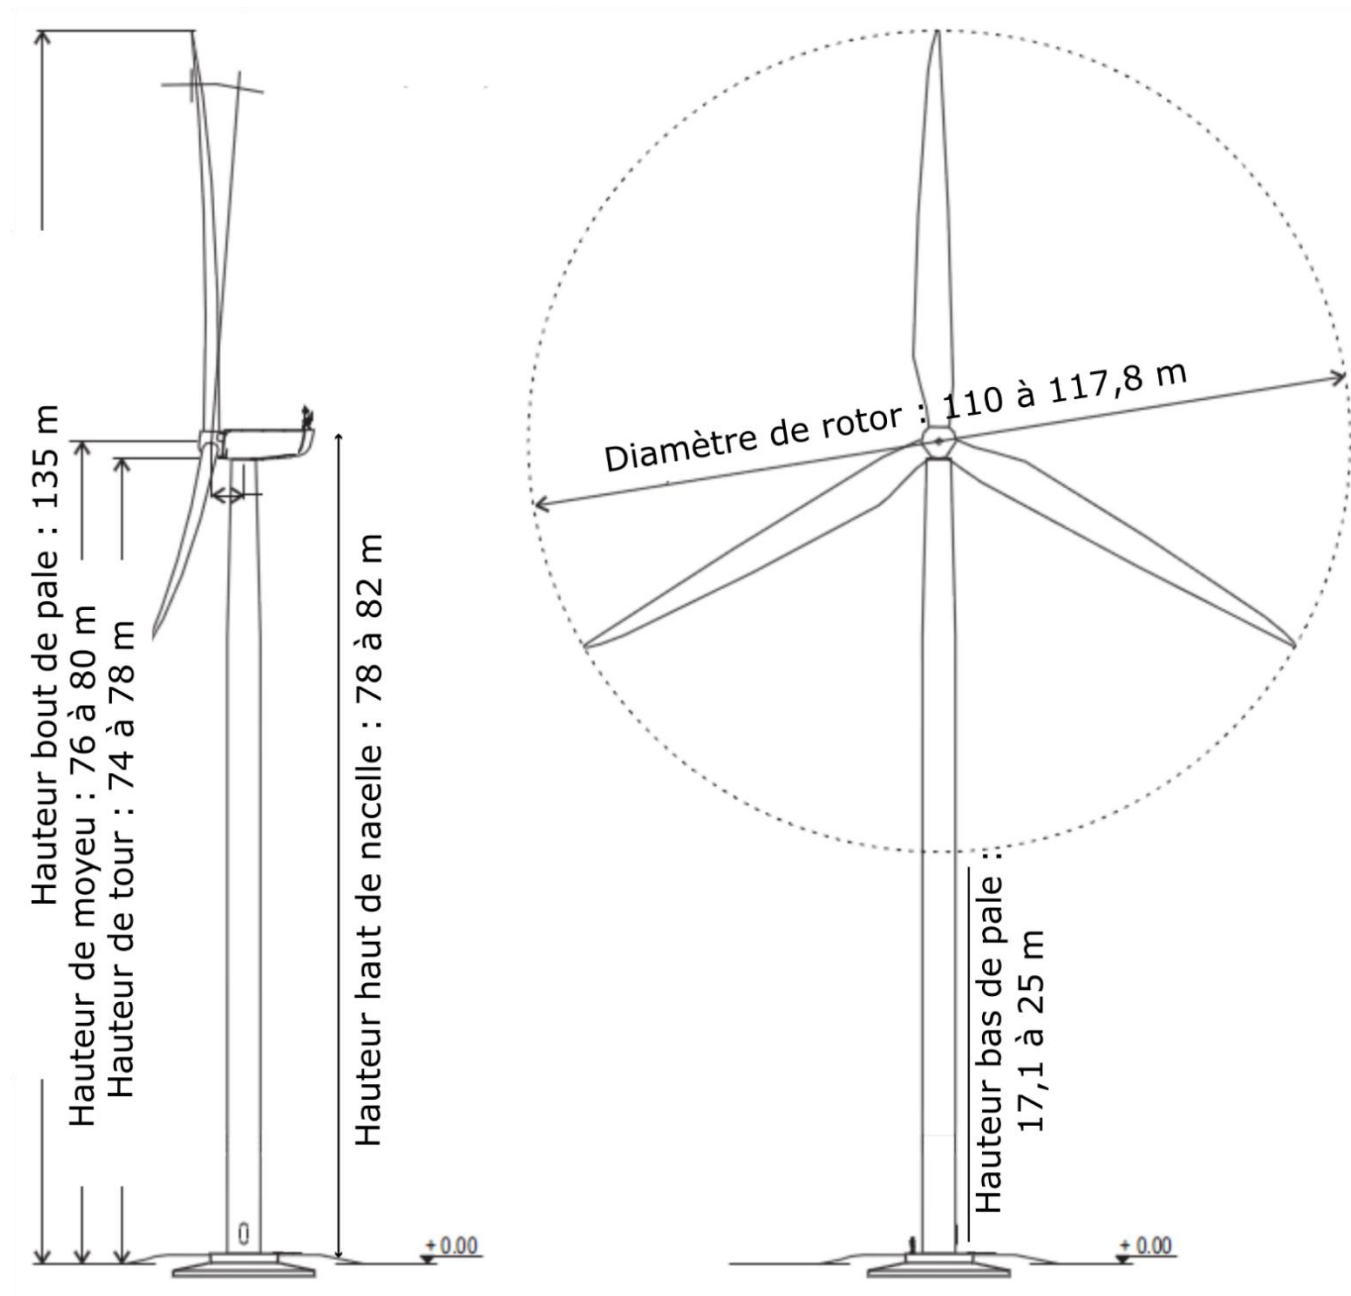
Plan d'élevation du gabarit-type d'éolienne prévu
